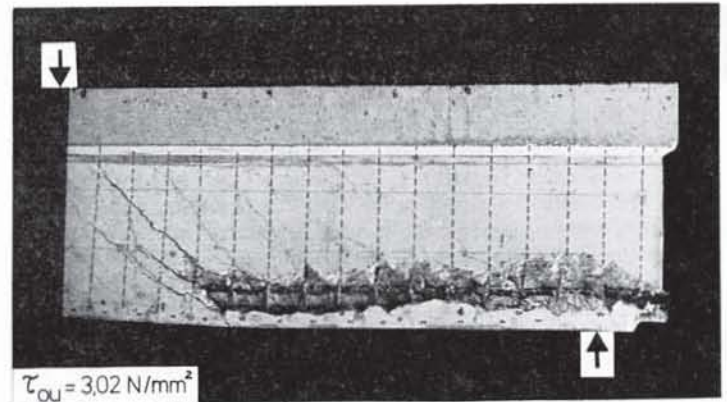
Bruchbild eines Balkens mit gestoßenen Bügeln durch Übergreifen der Winkelhaken (nach [45])
